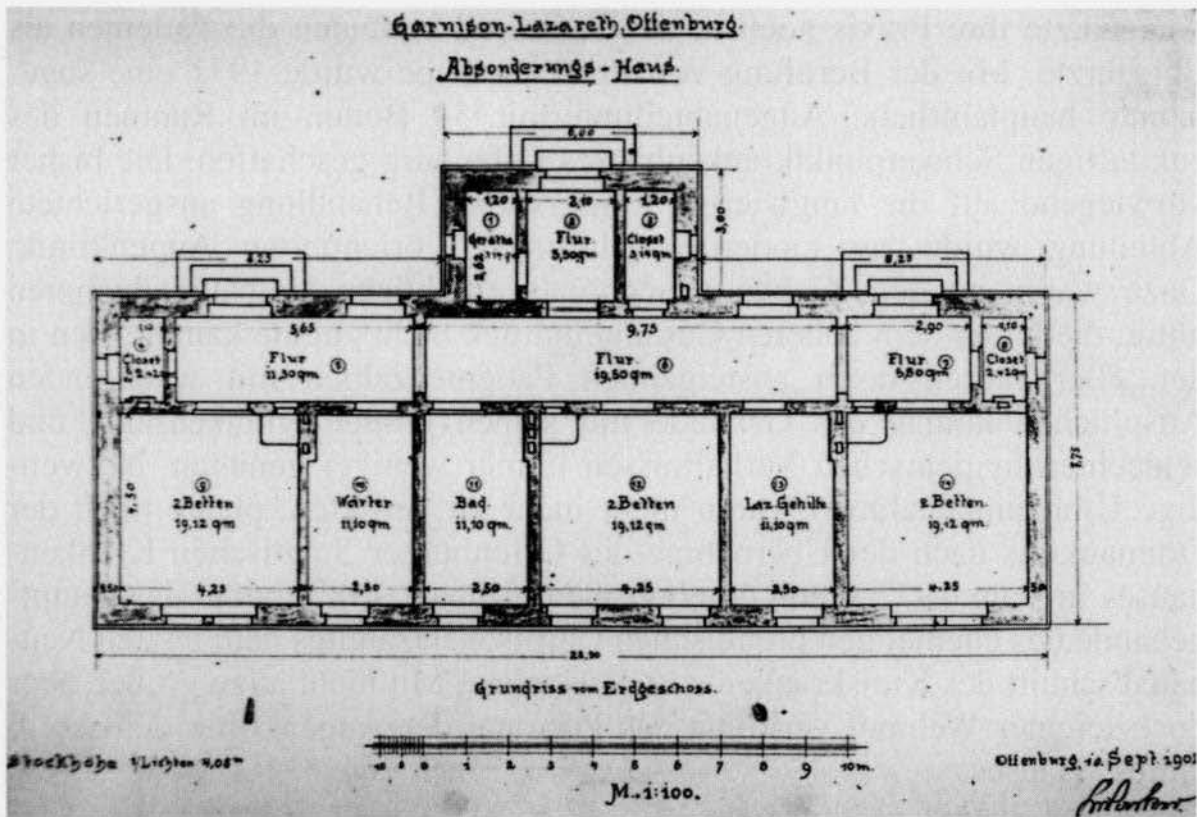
Grundriß mit Belegungsplan für das Absonderungshaus
